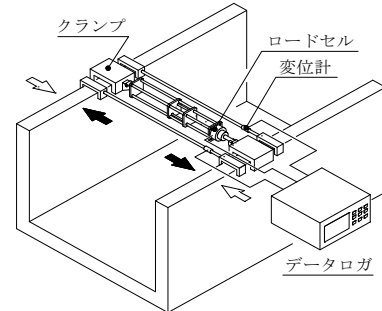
水路壁載荷装置 Channel Wall Loading Equipment
